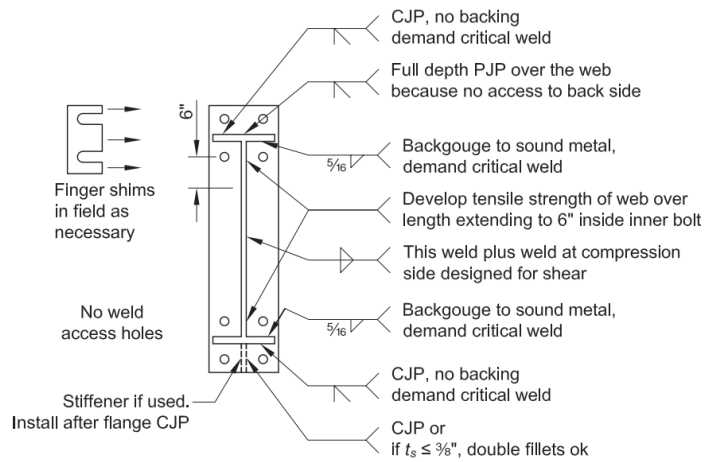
Detalles de soldadura entre la viga y la plancha extrema. Fuente: ANSI/AISC 358-22.
